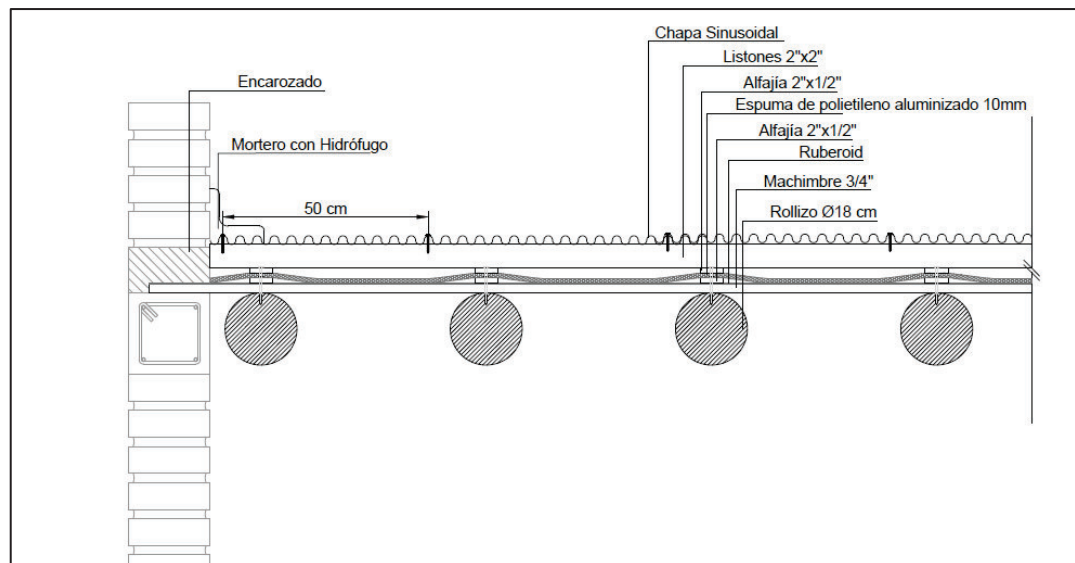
Detalle de cubierta para obra en el Barrio 12 de Mayo.
